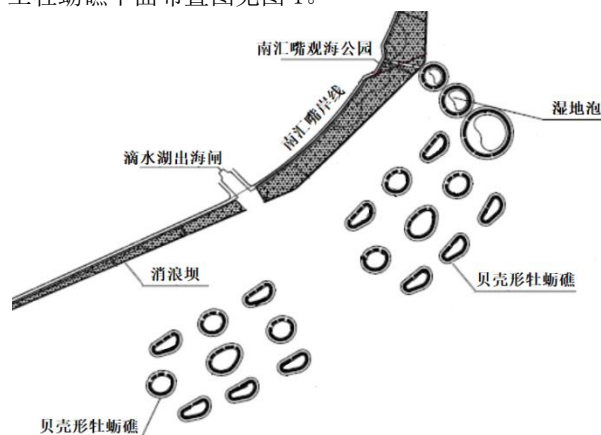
南汇嘴岸线人工牡蛎礁平面布置图
